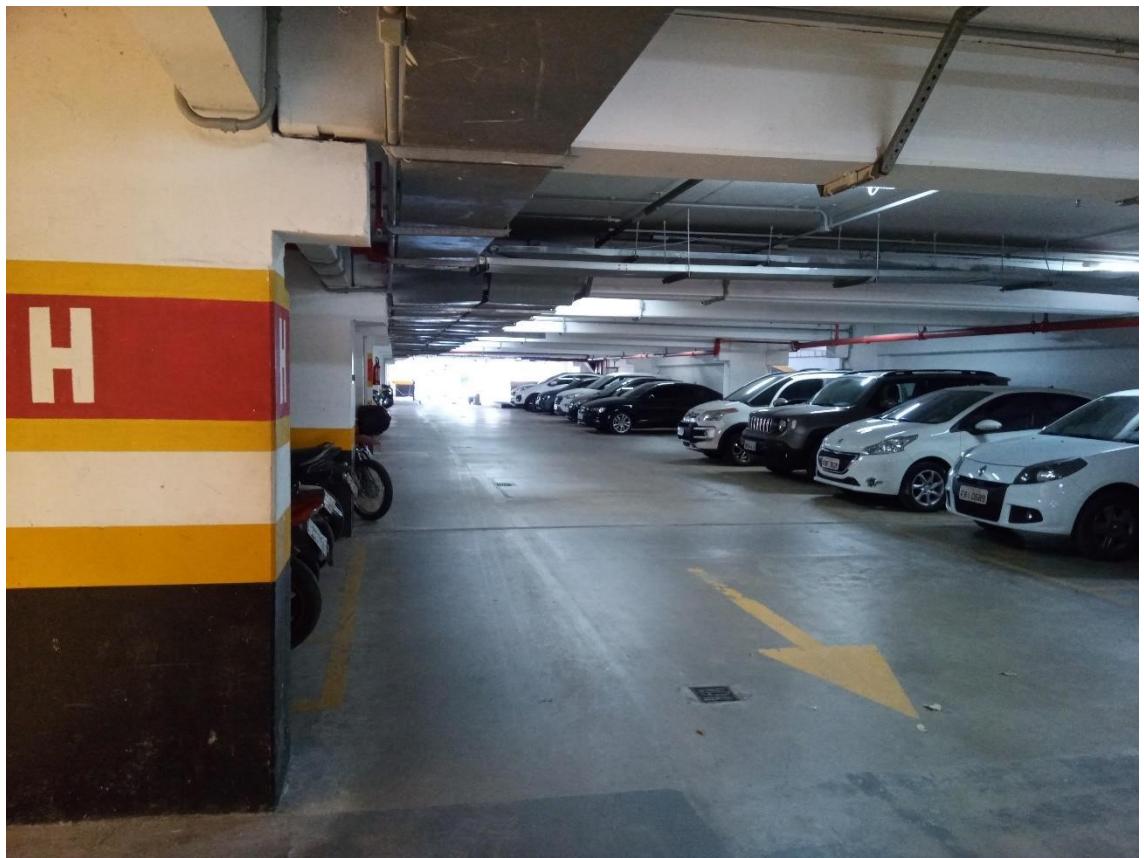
pavimento térreo – saída p/ Rua Guedes Coelho
